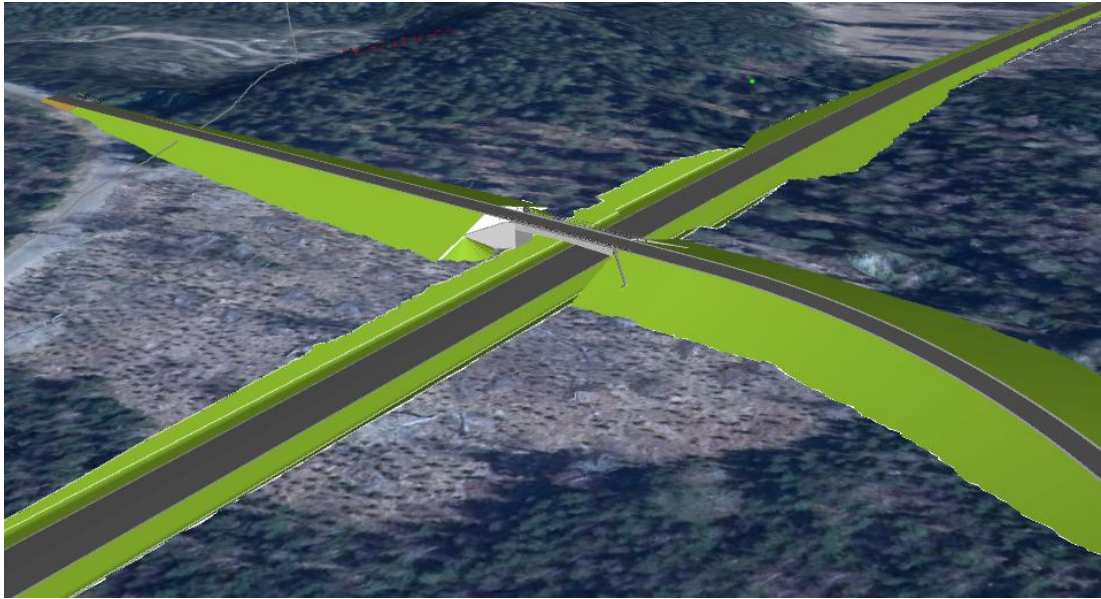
Illustrationsplan över platsspecifik gestaltning Bro Björn Waldegårds väg.
